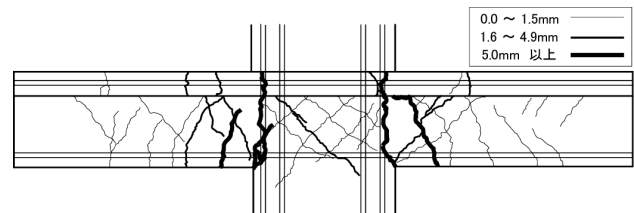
R=1/30 加力後のひび割れ図 (RCB)
